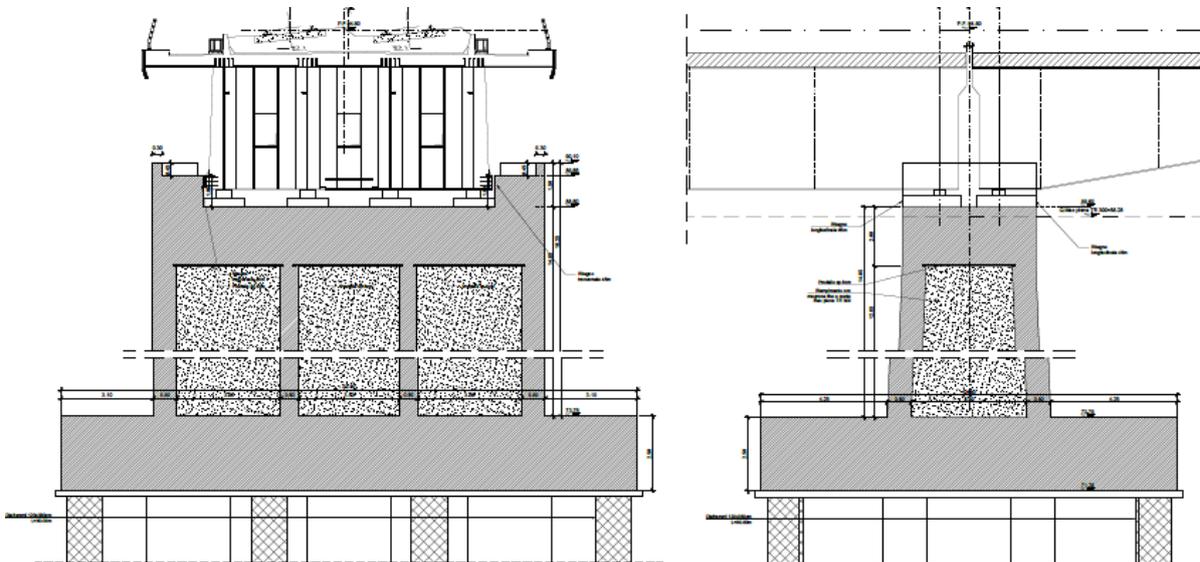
Sezione in direzione trasversale e longitudinale rispetto all'asse del viadotto P14
